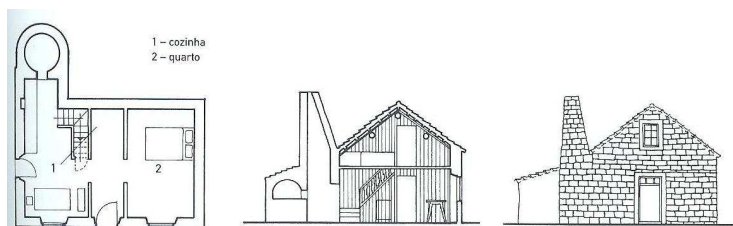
Planta, corte e alçado casa empena-fachada (APDA)
